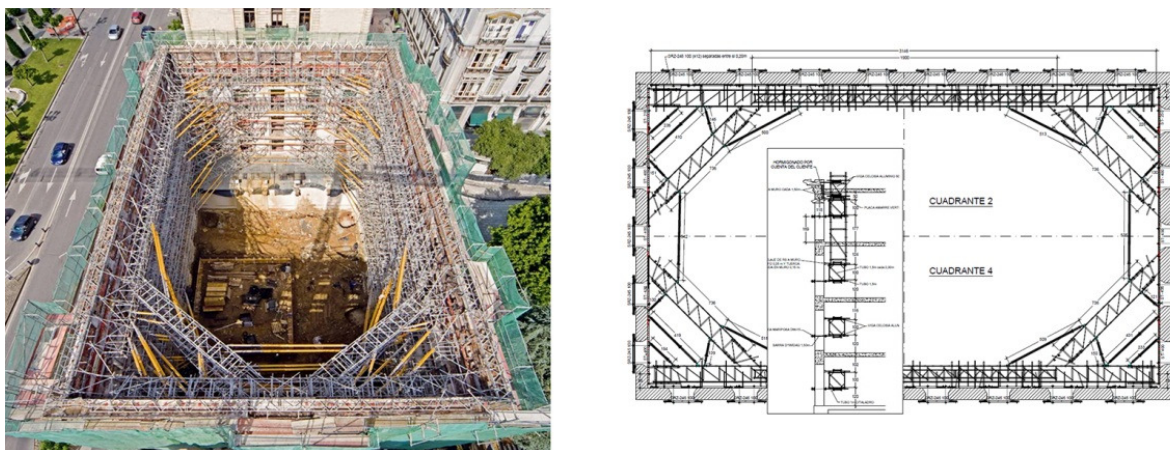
Widok zewnętrznych fragmentów tymczasowej konstrukcji stężącej
